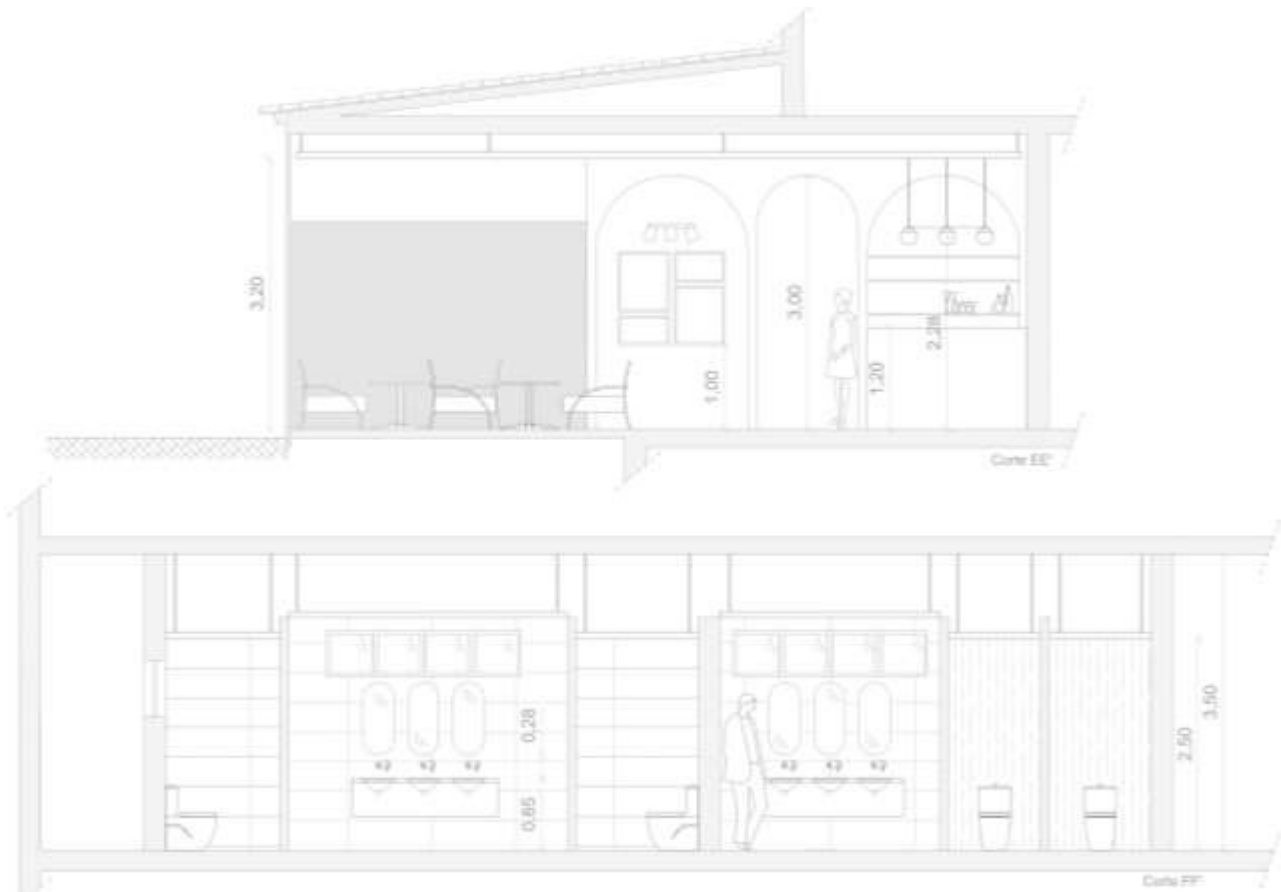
Corte transversal da Sala de Estar e Corte longitudinal das Instalações Sanitárias
